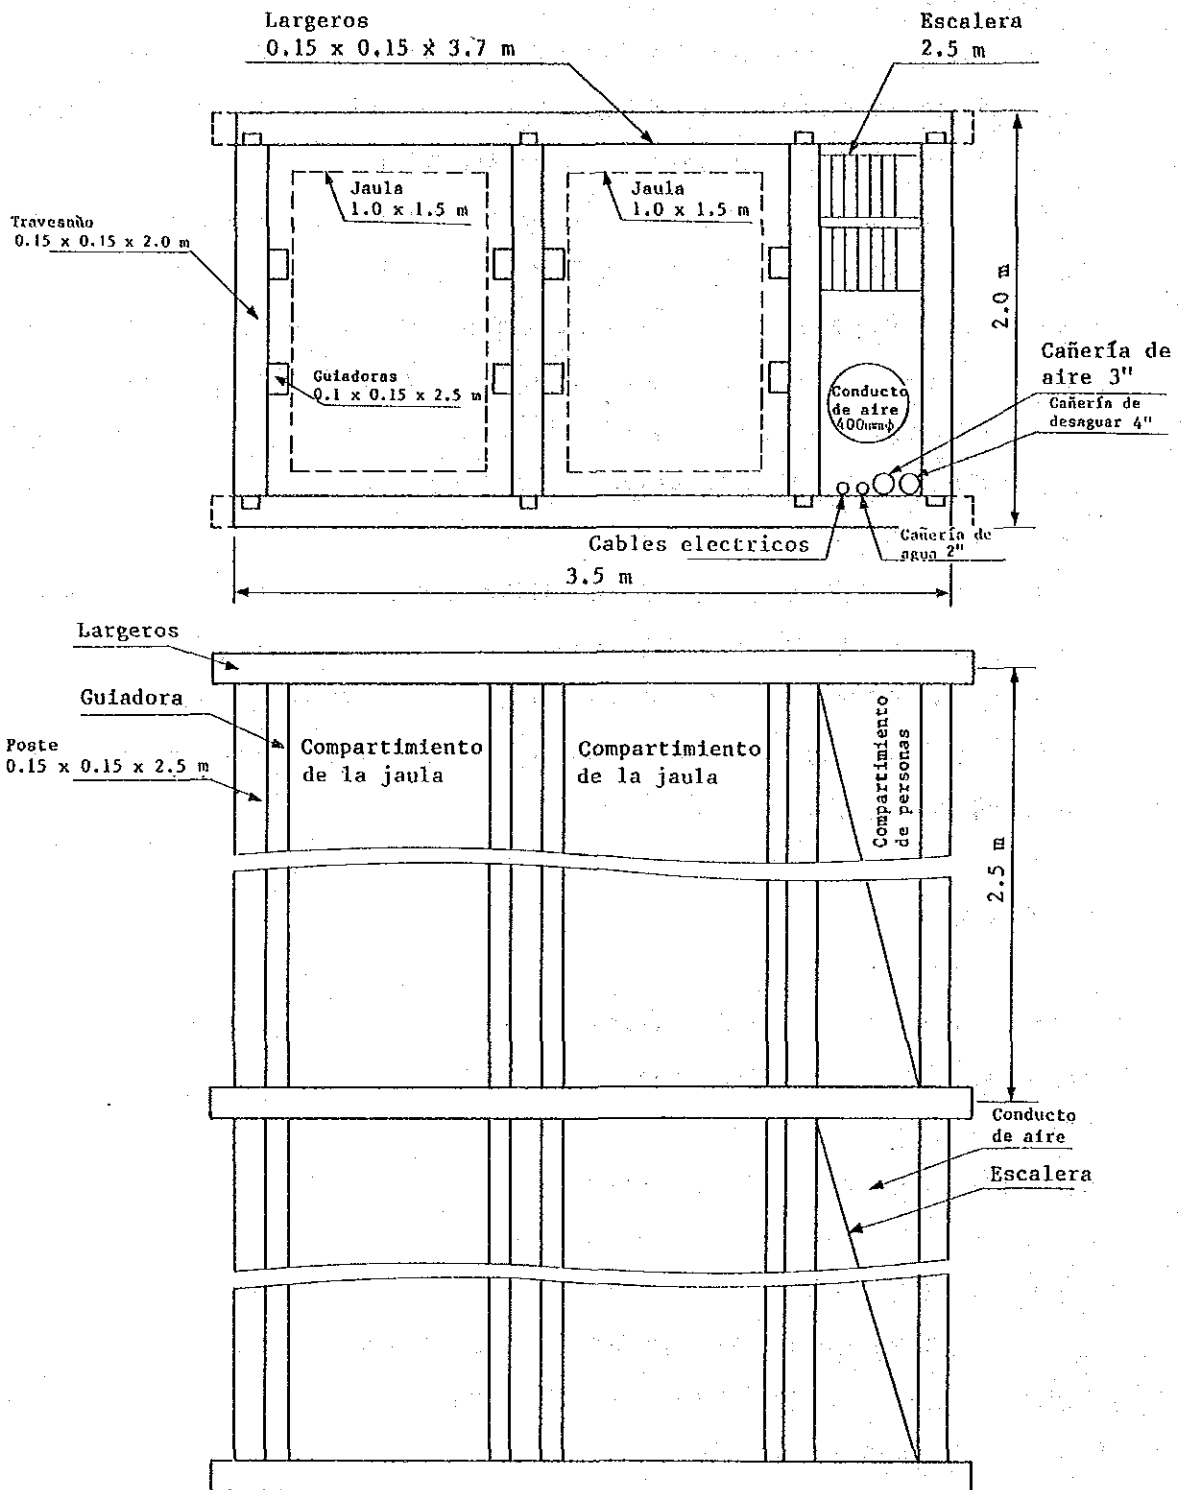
3 - 1 アルファ立坑平面図及び断面図 S-1/30
